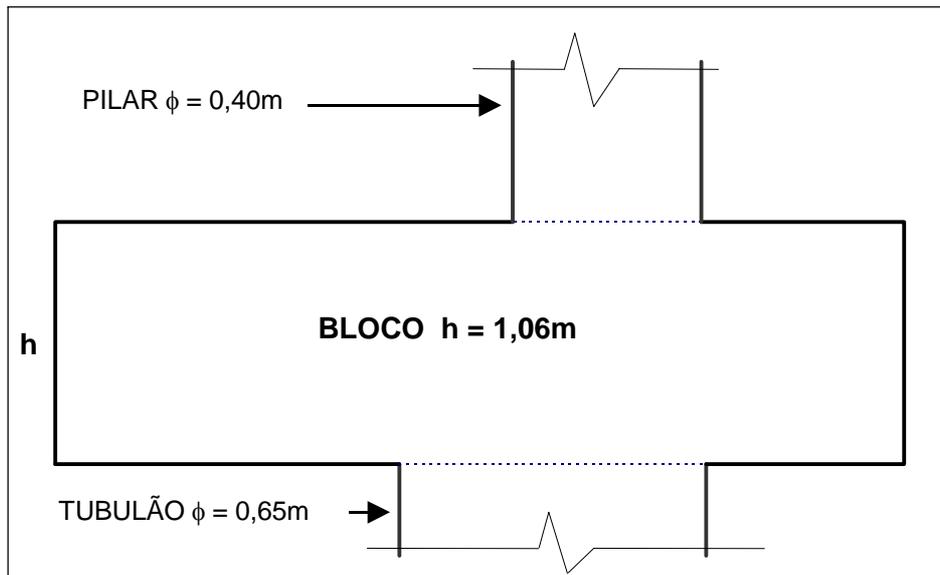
Conjunto pilar, bloco e tubulão, de apoio da escada – sem escada.
